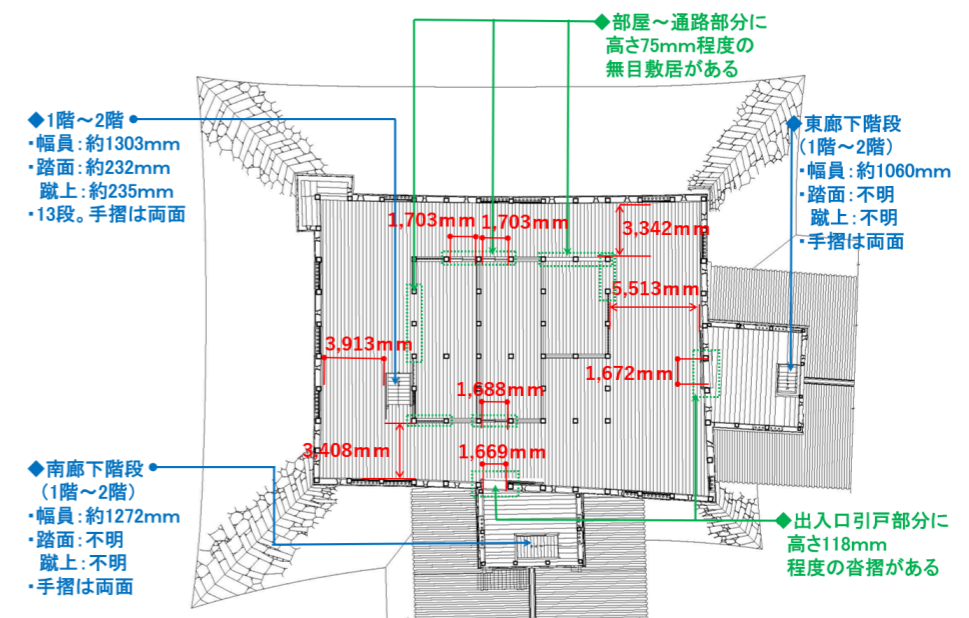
天守 1 階平面図及び東廊下・南廊下 2 階平面図（復元原案）
